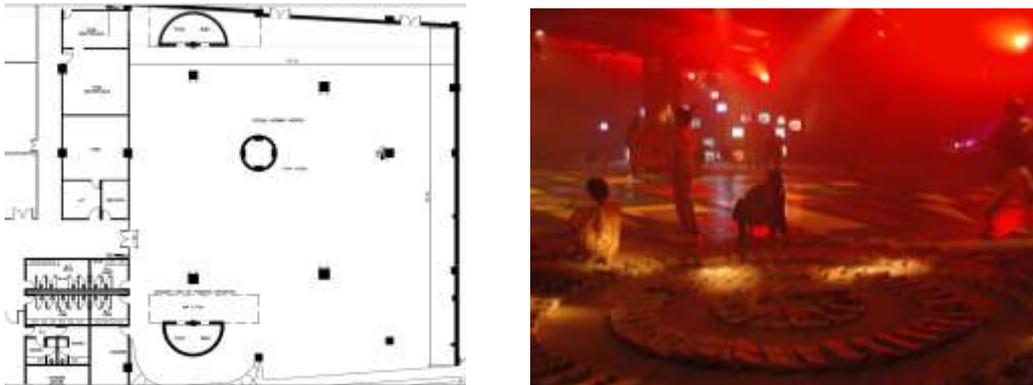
e 54: Planta e foto da Sala Jardel Filho (respectivamente)
